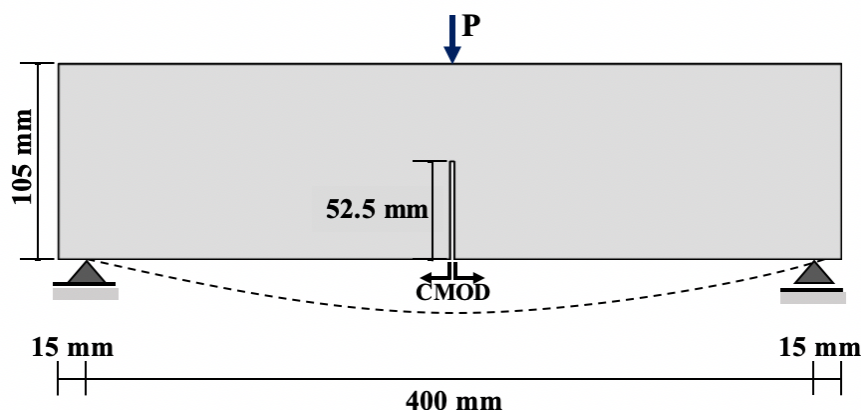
Configuração das vigas ensaiadas por CASUCCIO et al. (2008)
